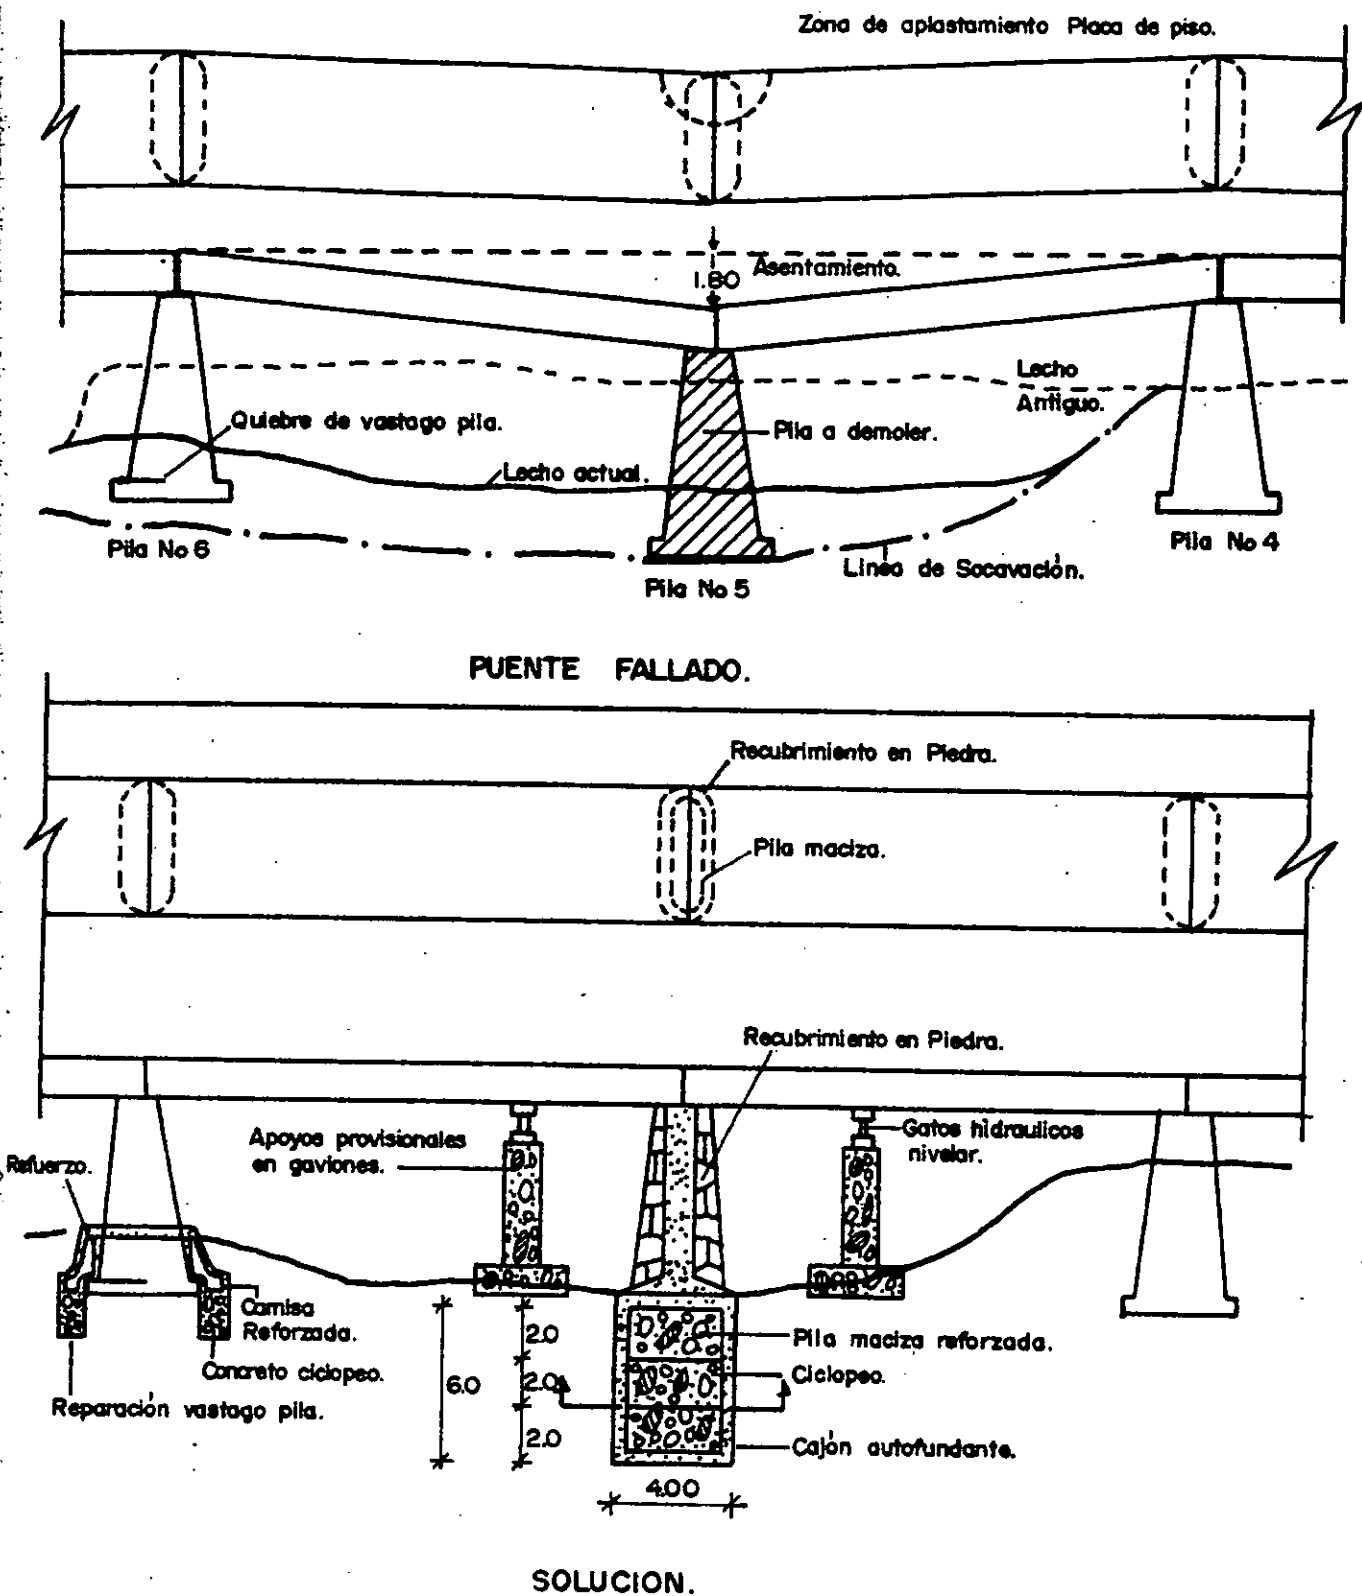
Reconstrucción de la cimentación, según Guevara (1998)⁽⁸³⁾.
